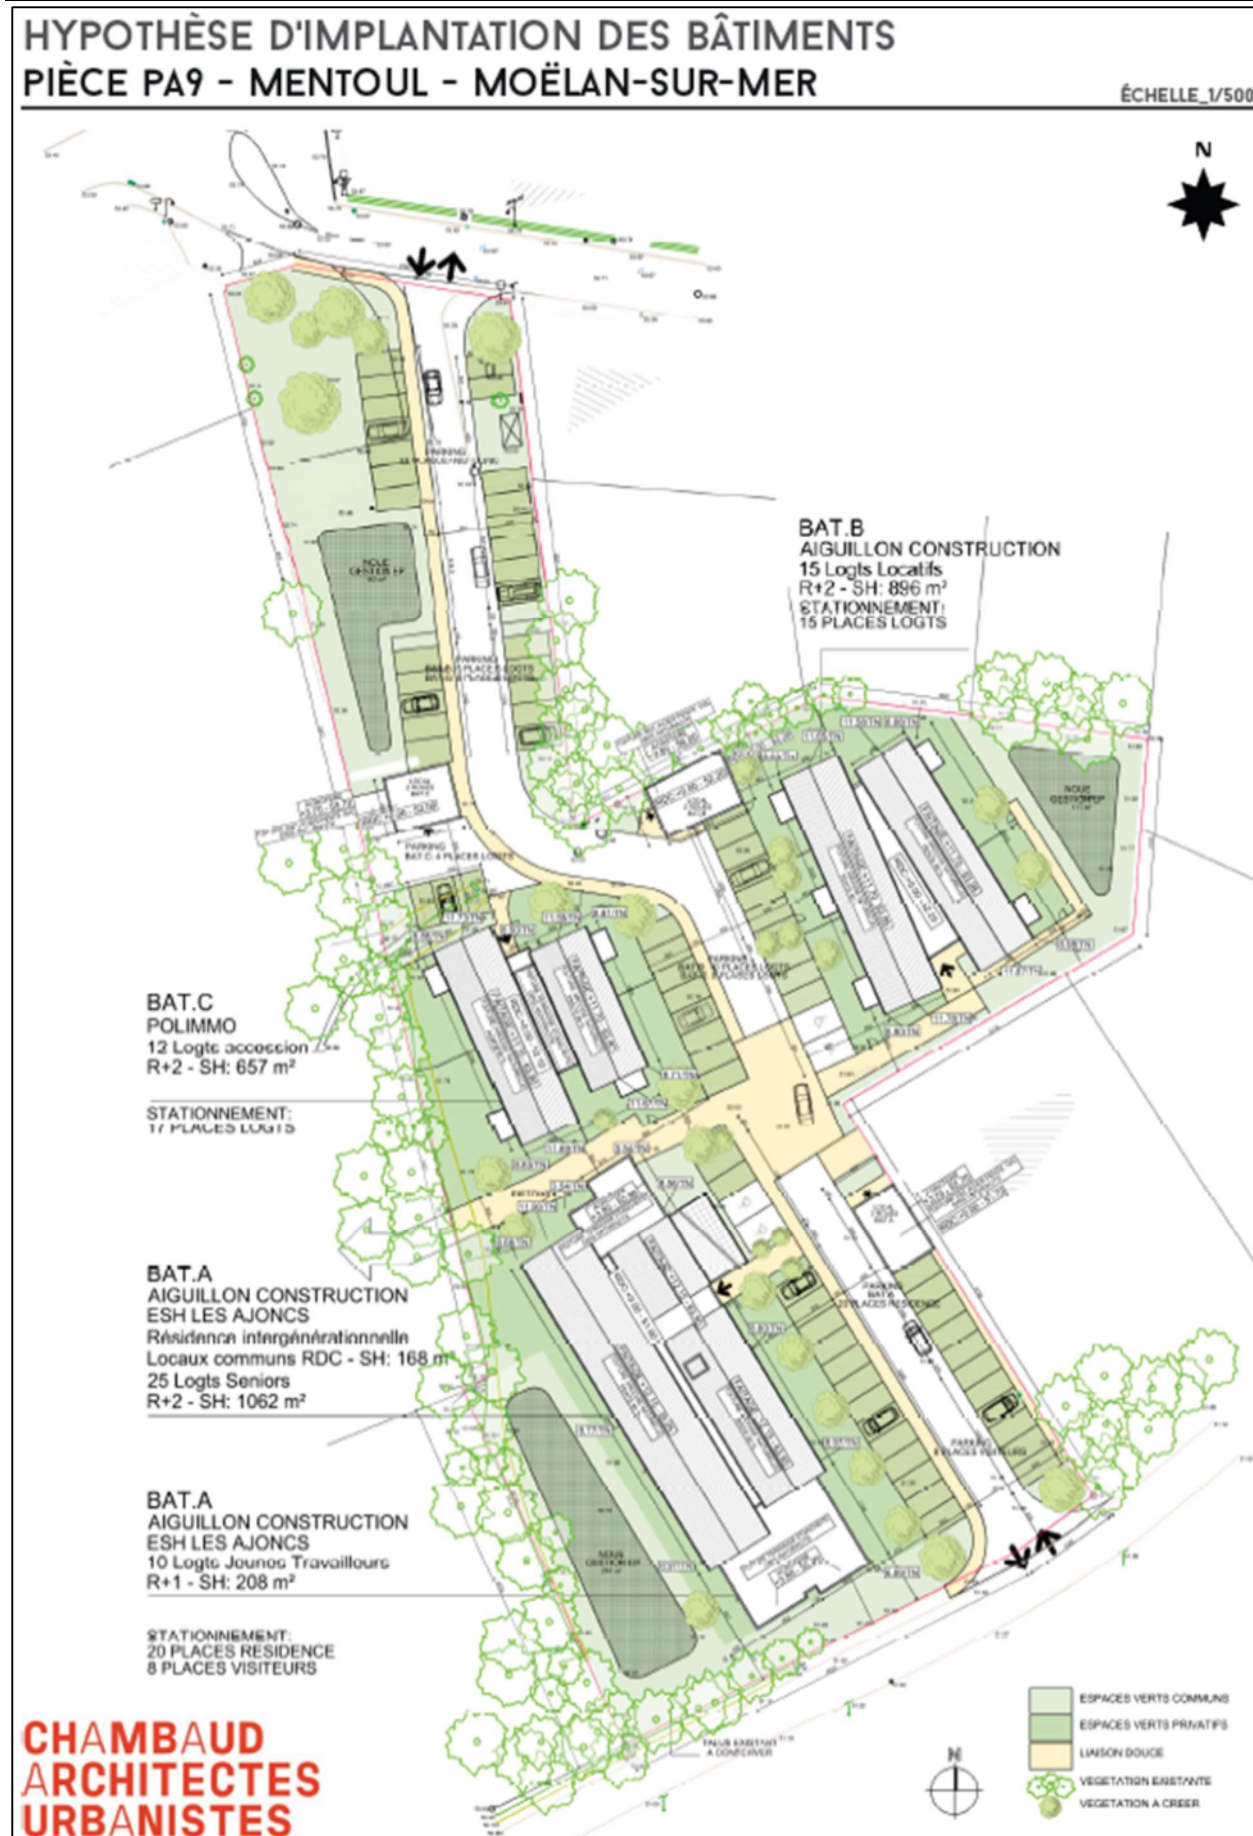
Plan d'implantation des bâtiments (source : Chambaud Architectes Urbanistes – juin 2024)
